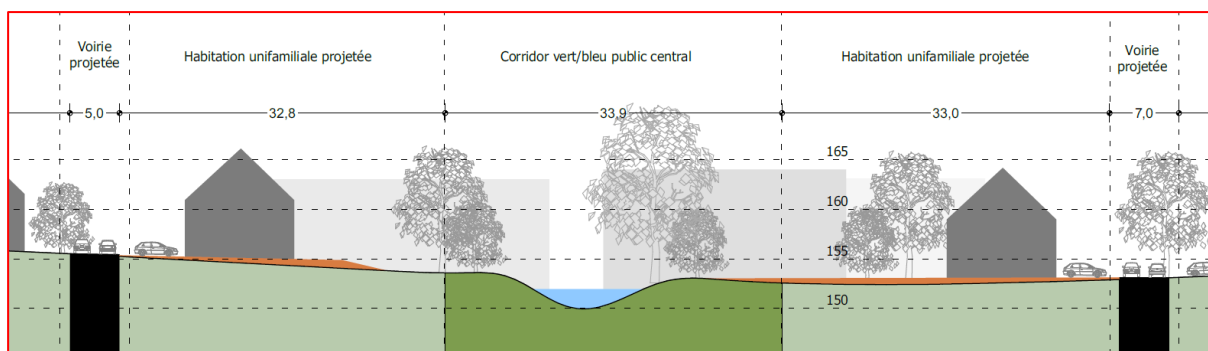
Coupe de principe perpendiculaire au corridor vert et bleu et zoom © DR(EA)²M – 2023
